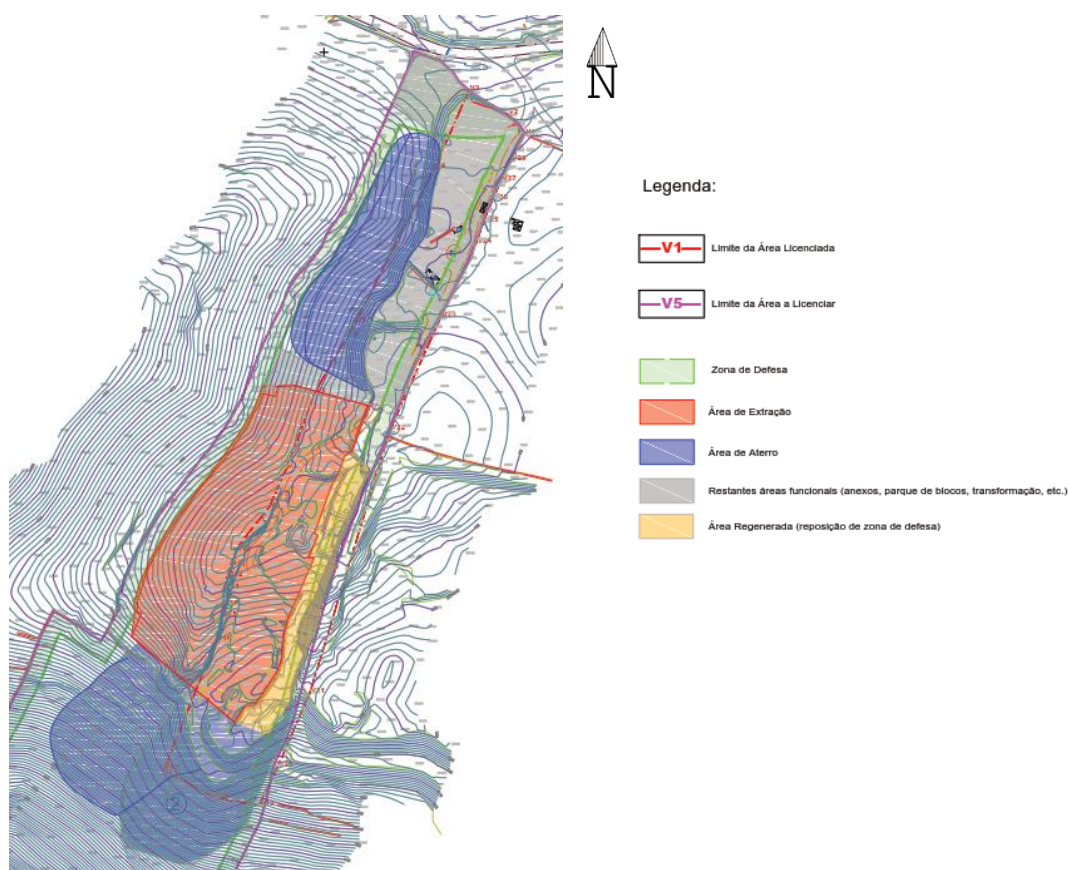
Zonamento proposto (s/escala) (ver também planta anexa).
